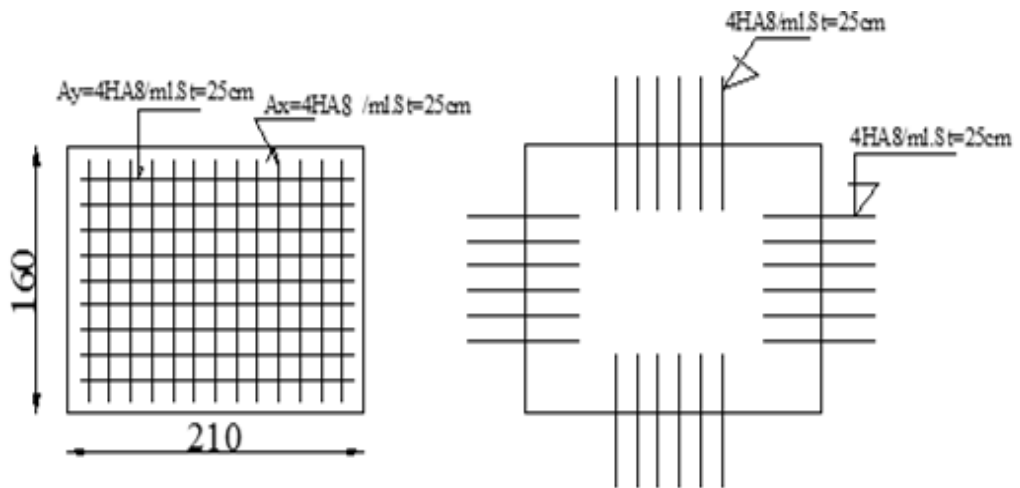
Schéma de ferrailage de la dalle au-dessous de l'ascenseur
